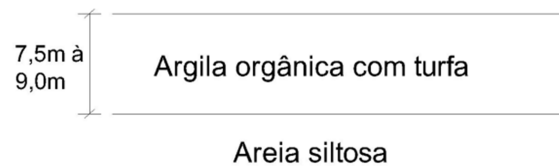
Detalhe esquemático do perfil em estudo da Área A.
